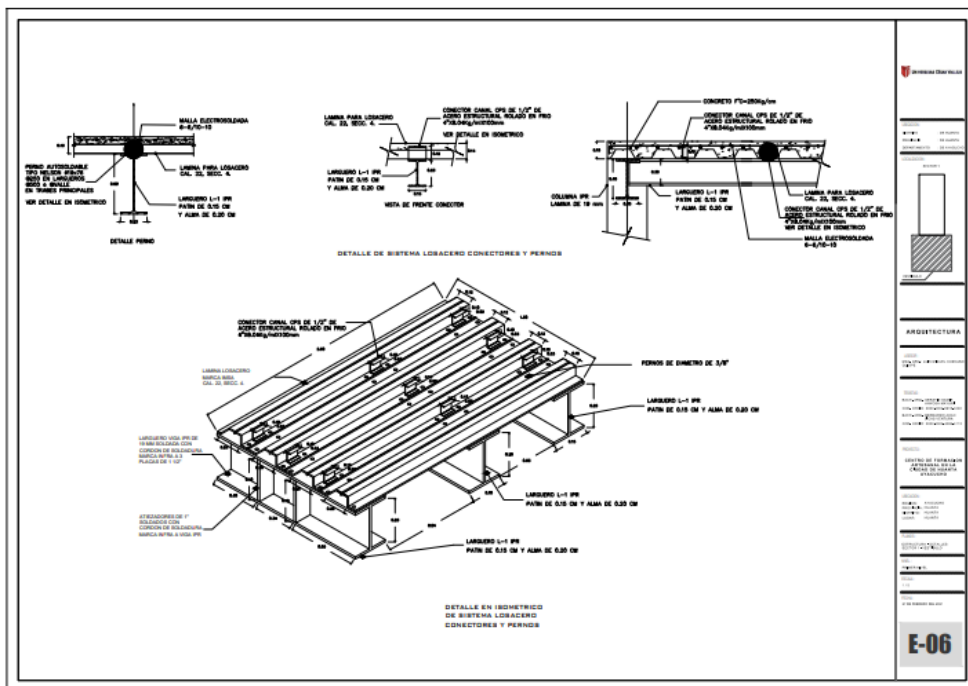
Plano de detalles de la cubierta - escala 1/5.
